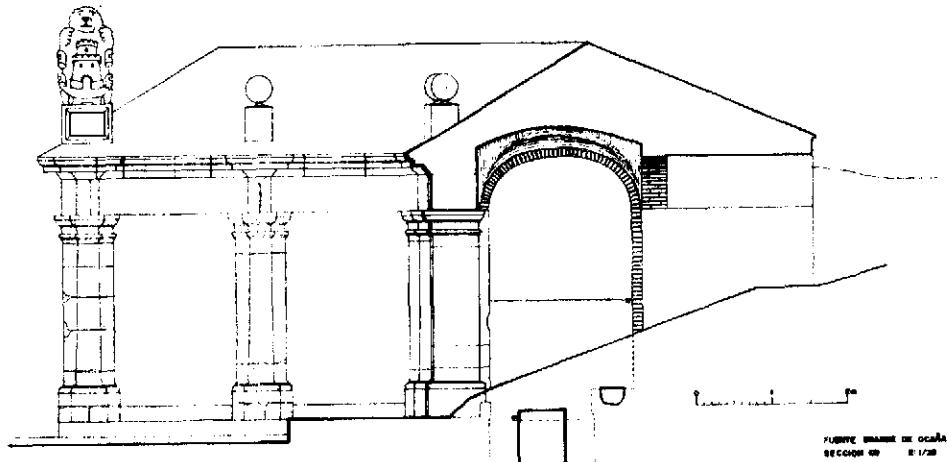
Sección del pórtico y pilón de la fuente. E. 1 : 100
